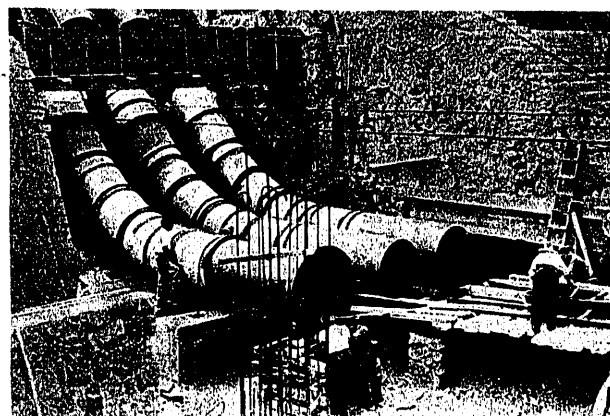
Tuberías forzadas en el punto más bajo de anclaje, contiguo a la central.
